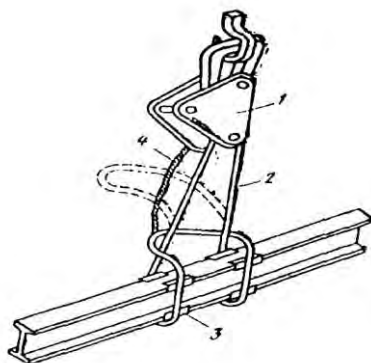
Схема узла строповки связей и распорок: 1 -полуавтоматический захват;. 2 — универсальный строп;. 3 - валик; 4 — поводок;. 5 - скоба такелажная
